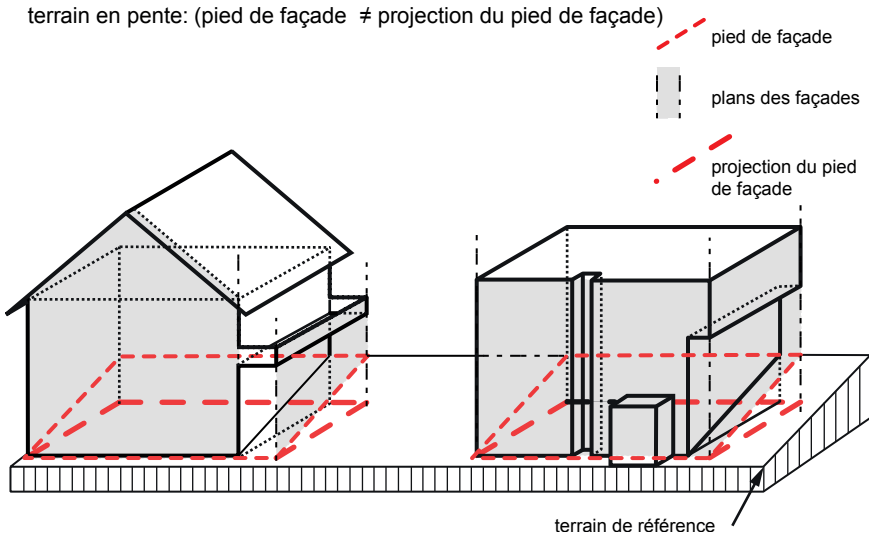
b Plans de façades et projection du pied de façade (sur terrain en pente)
